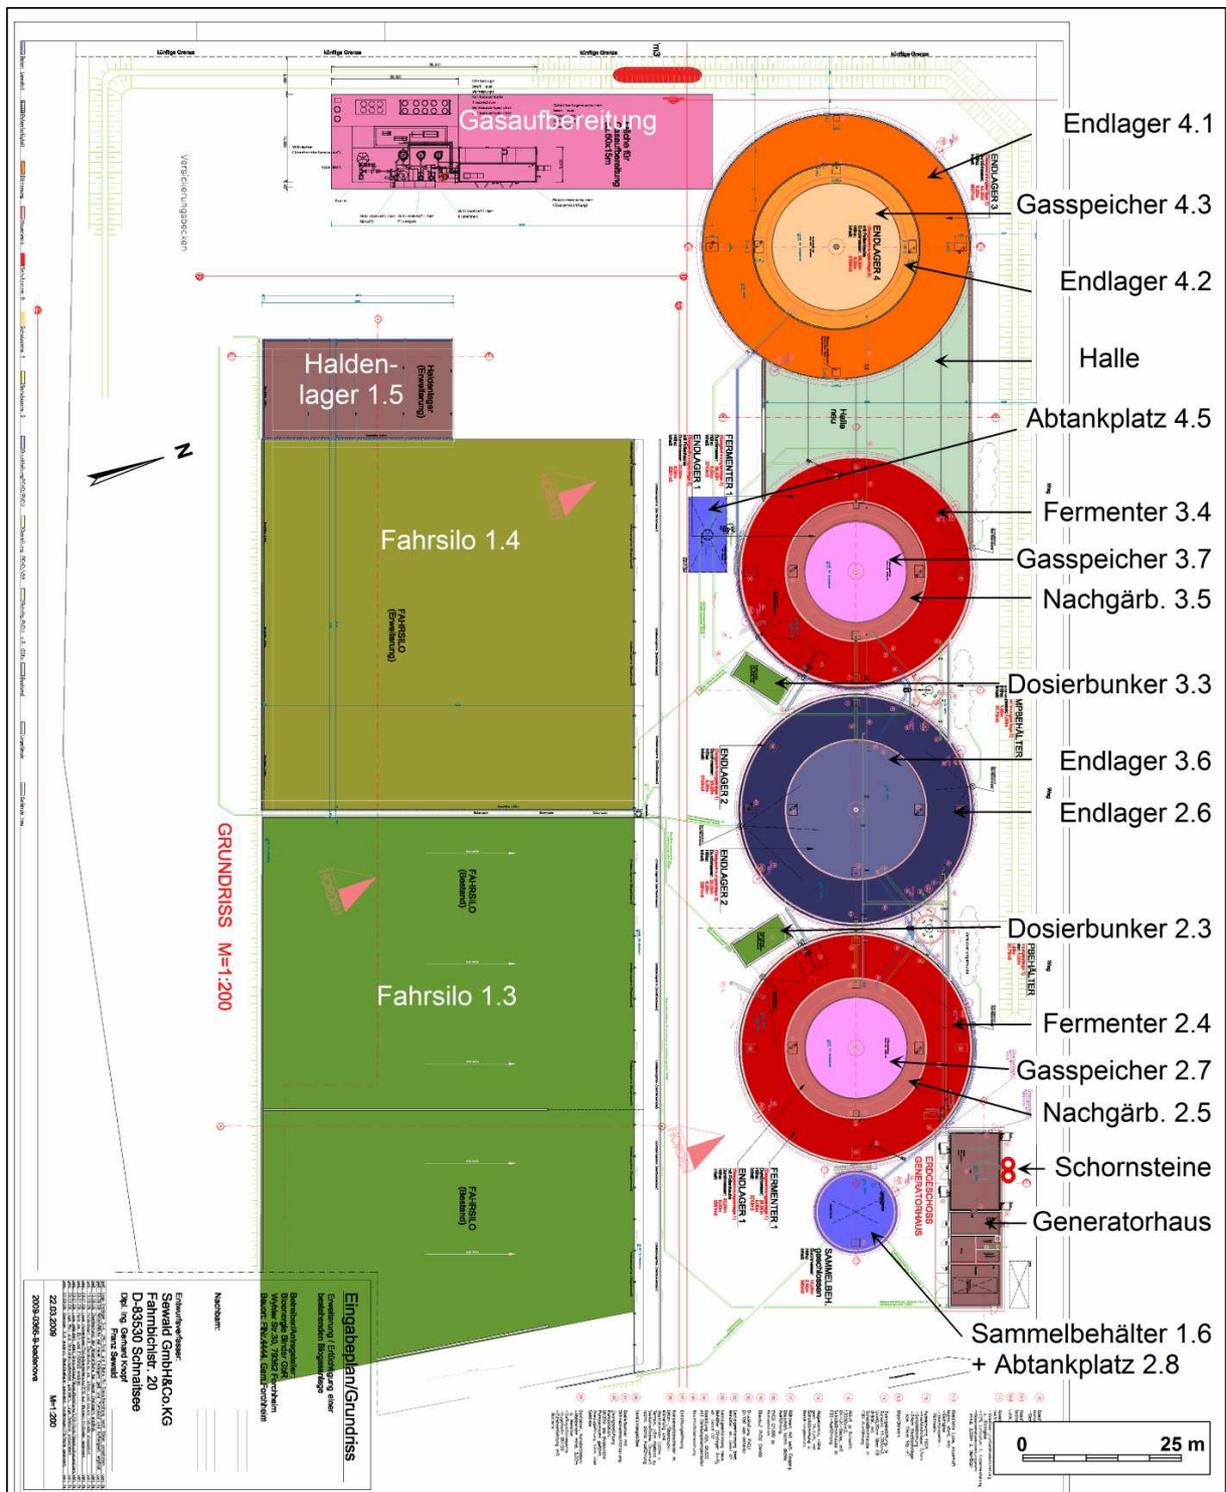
(farbig): Lage der vorhandenen Anlagenteile und Emissionsquellen auf dem Betriebsgelände. (Plangrundlage: Sewald GmbH & Co.KG, Eingabeplan/Grundriss, Plan-Nr.2009-0366-9-badenova, 22.03.2009)
